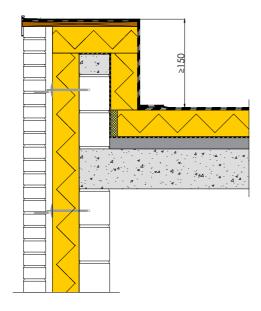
Hauteur de l'acrotère pour toiture avec lestage
